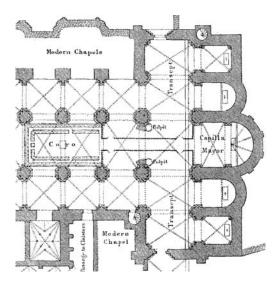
Tudela. Catedral, planta del ábside y crucero (Street [1865] 1926)
